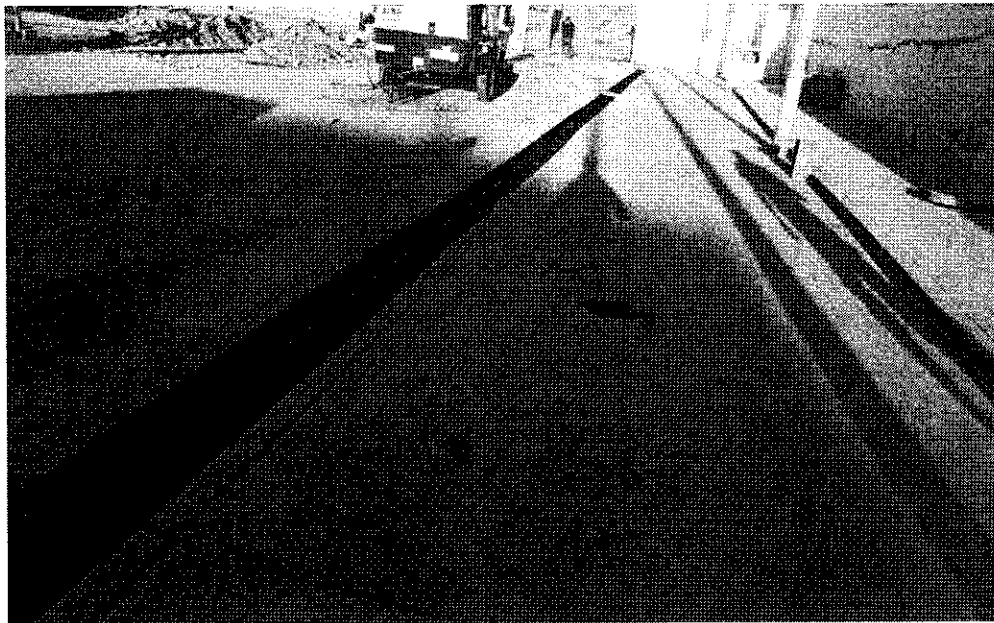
CANALETAS DE CONCRETO CON REJILLAS METALICAS.
